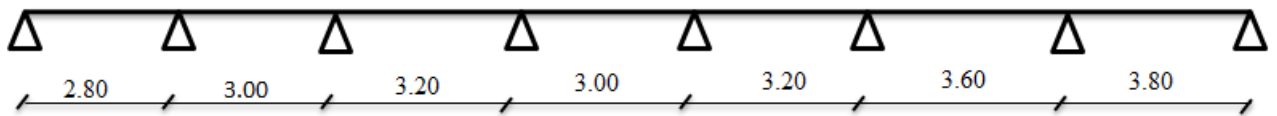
Poutrelle type 01 Plancher RDC (terrasse accessible)
